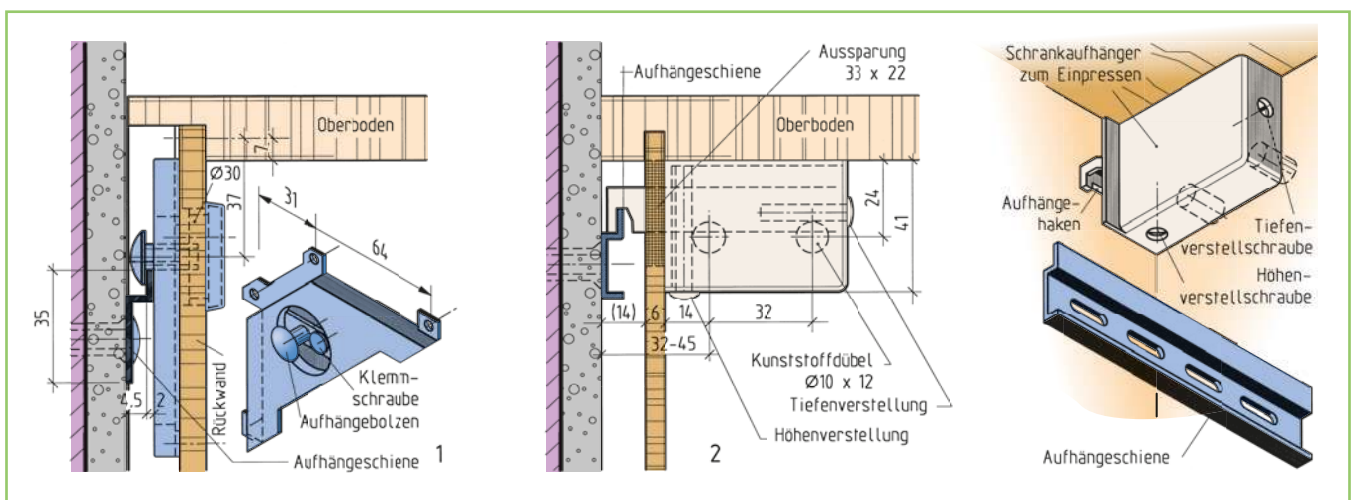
Aufhängemöglichkeit von Wandschränken wie Küchen-Oberschränke mit Beschlägen. 1 Hängebeschlag wird in die oberen Ecken des Möbels von hinten gegen die Korpuskanten geschraubt. Durch eine Bohrung in der Rückwand kann der Aufhängebolzen, der in eine Metallschiene fasst, verstellt und arretiert und der Schrank dadurch ausgerichtet werden. 2 Hängebeschlag wird oben in die hinteren Schrankecken gegen die Seiten gedübelt. Der höhen- und tiefenverstellbare Aufhängehaken fasst durch eine Aussparung der Rückwand in eine Metallschiene.
